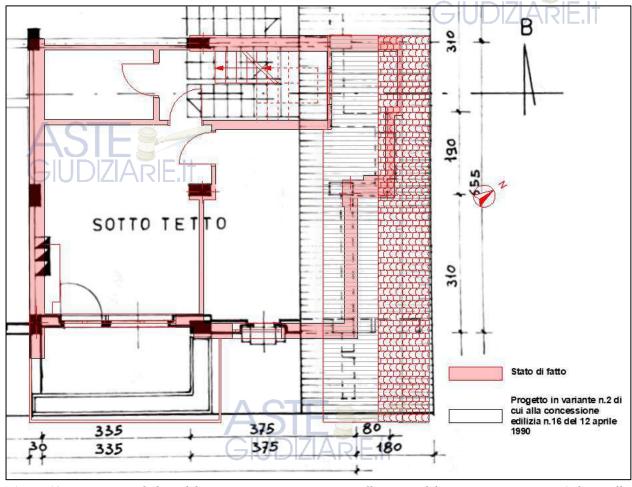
Pianta stato di fatto del piano sottotetto sovrapposta alla pianta del progetto in variante n.2 di cui alla concessione edilizia n.16 del 12 aprile 1990.
